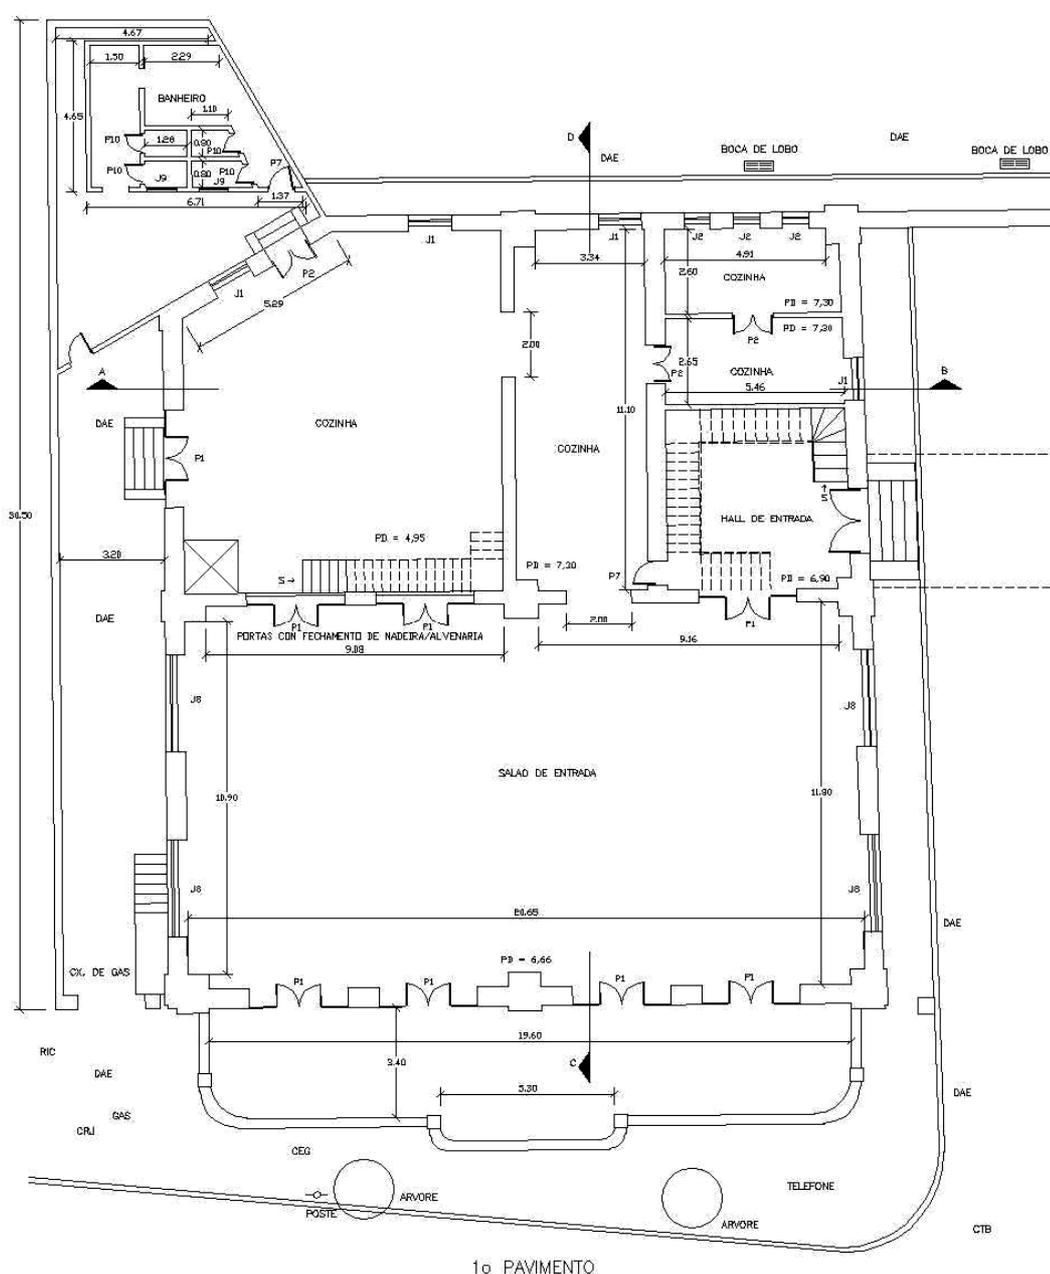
Planta baixa de levantamento do 1º pavimento do Prédio Anexo da CEU. Fonte: Projeto de Restauo RB762 UFRJ, 1995.
